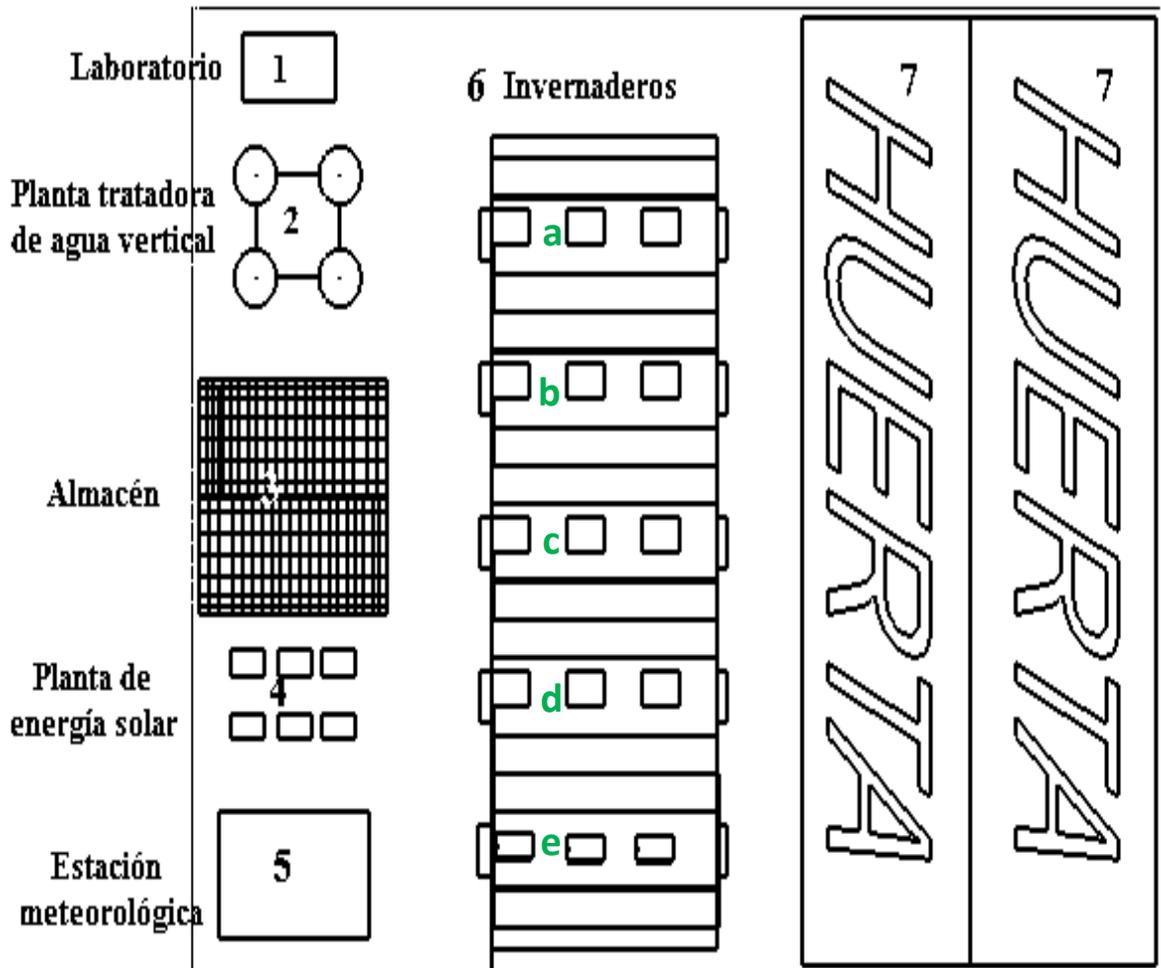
Planta general de propuesta de invernadero para cultivo hidropónico.
